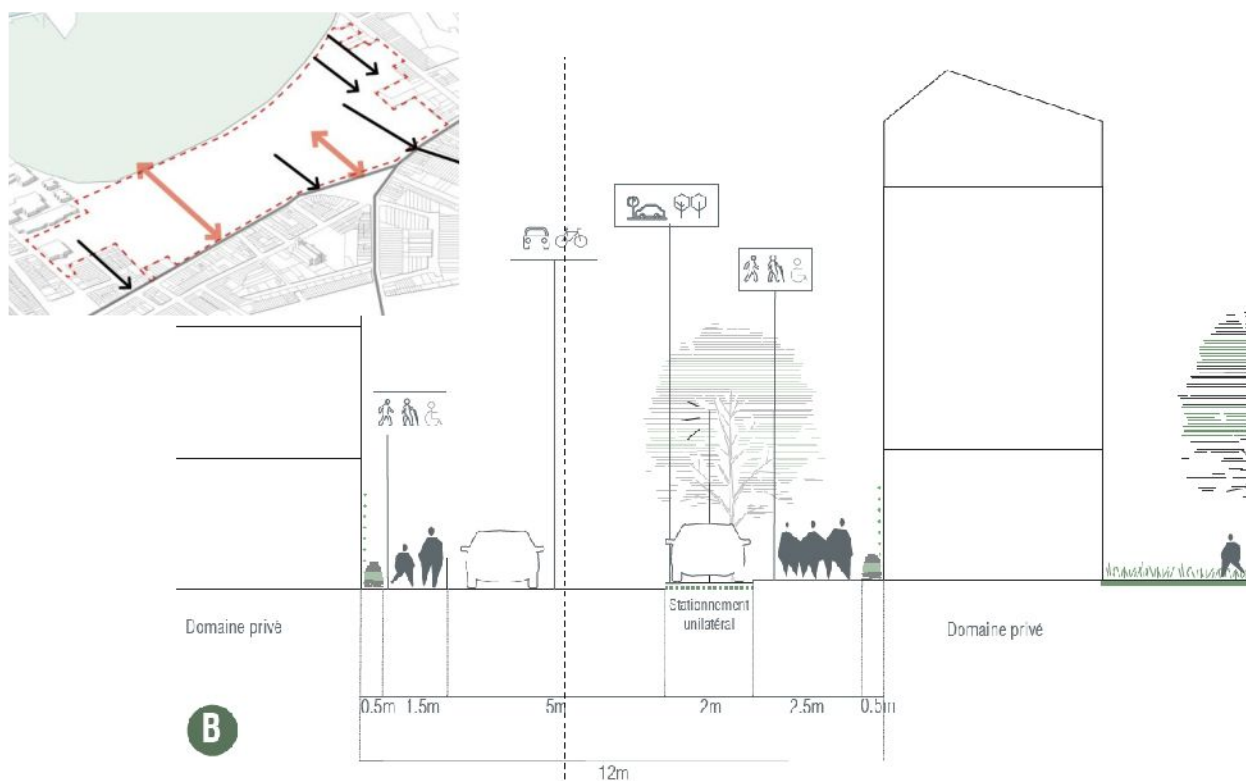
Coupe d'une voirie secondaire – Source : CPAUPE
